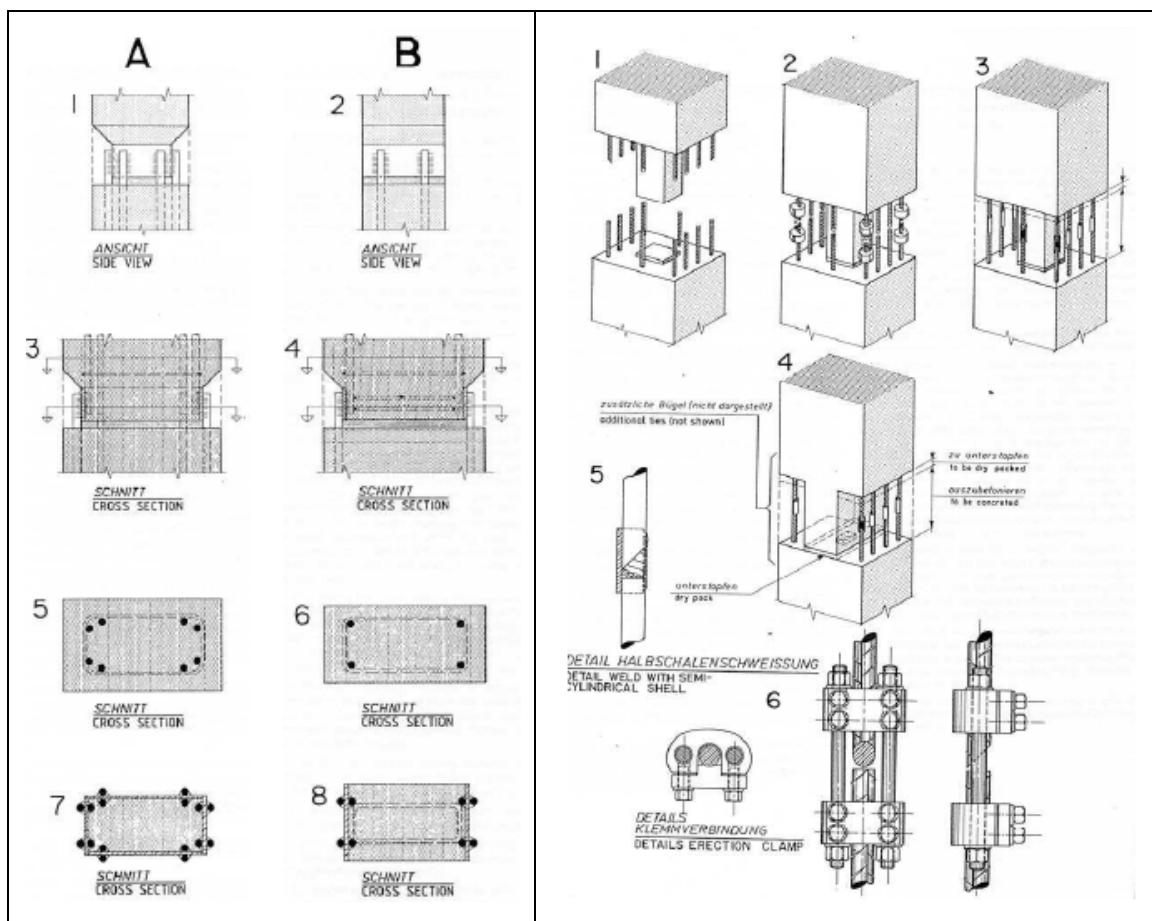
Ligação por soldadura de chapas a varões (Stupré, 1981)
